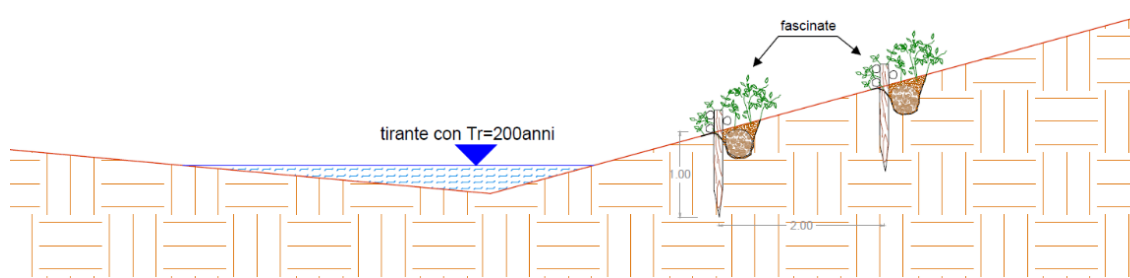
Particolare sezione 3.5\_Punto 12.357
